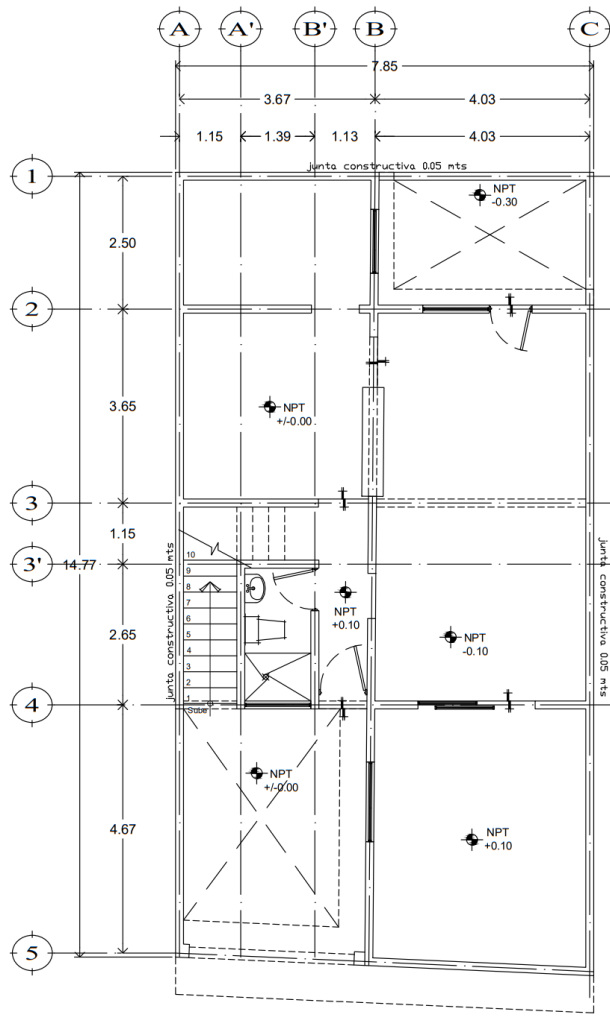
Levantamiento arquitectónico, segundo nivel.
